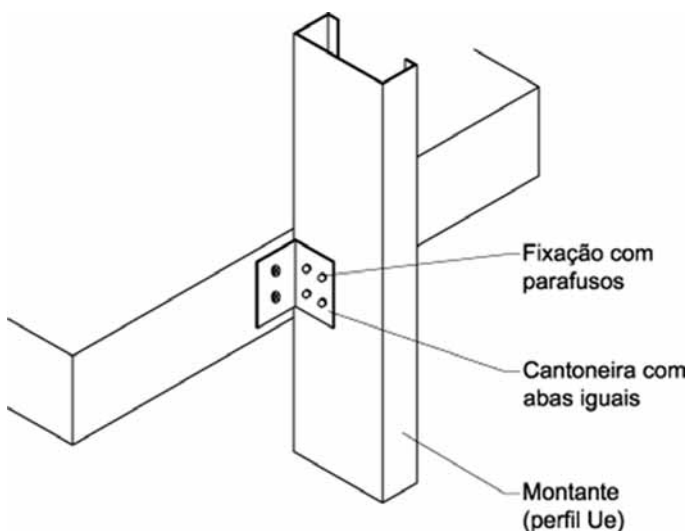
Conexão rígida entre montante e estrutura executada com cantoneira comum
